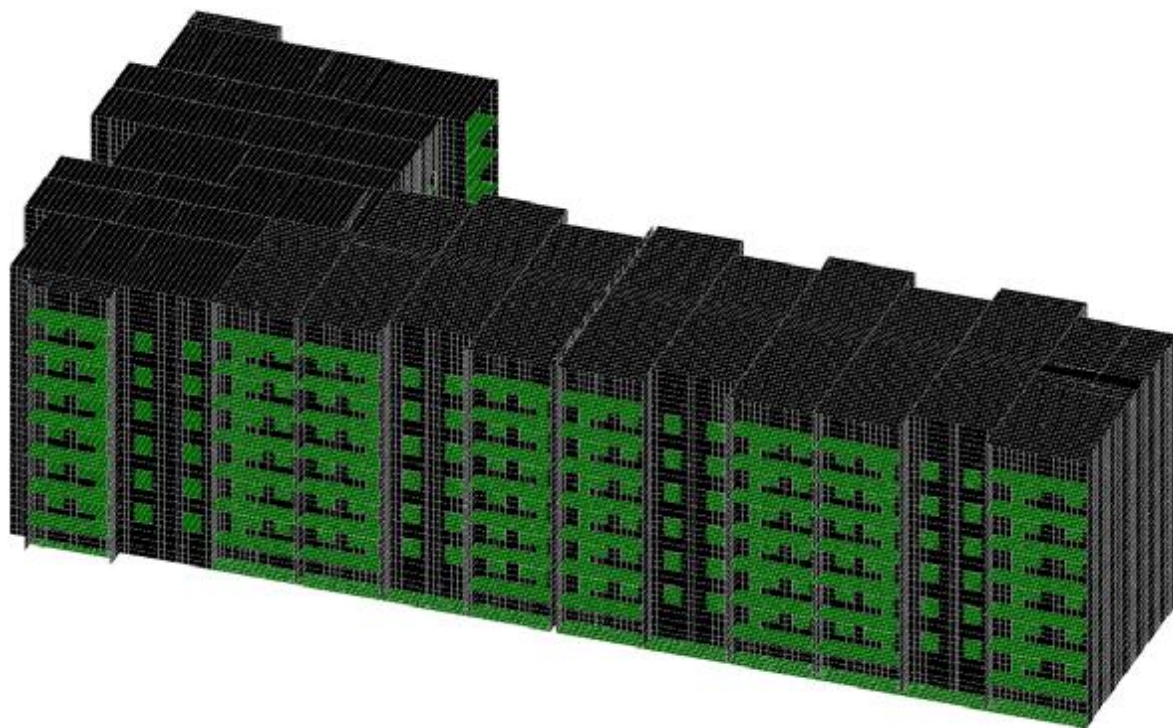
Нагрузка на здание (полы + потолки)
